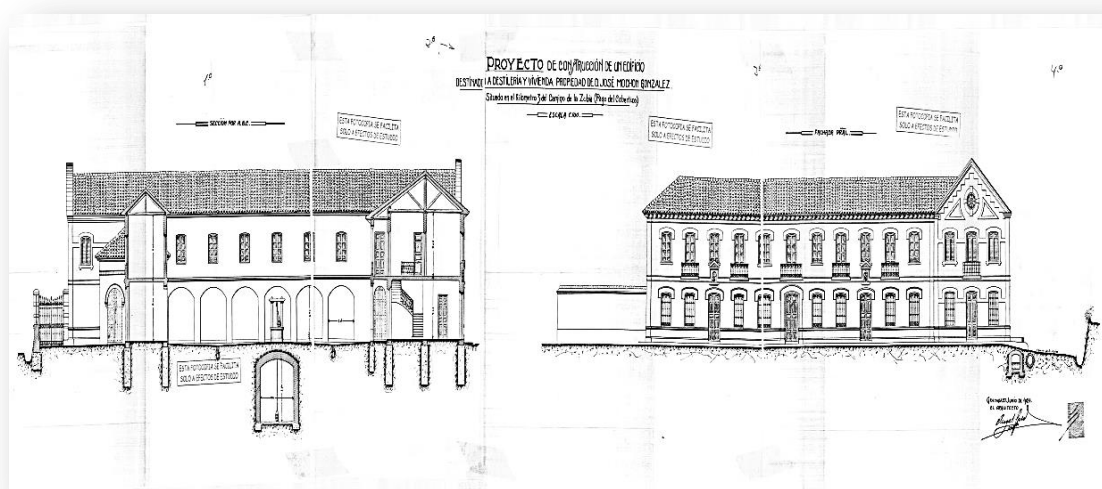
Plano del proyecto de construcción de una destilería de José Mochón. Alzado y sección. Arquitecto Ángel Casas. Año 1924. Fuente: AHMG
